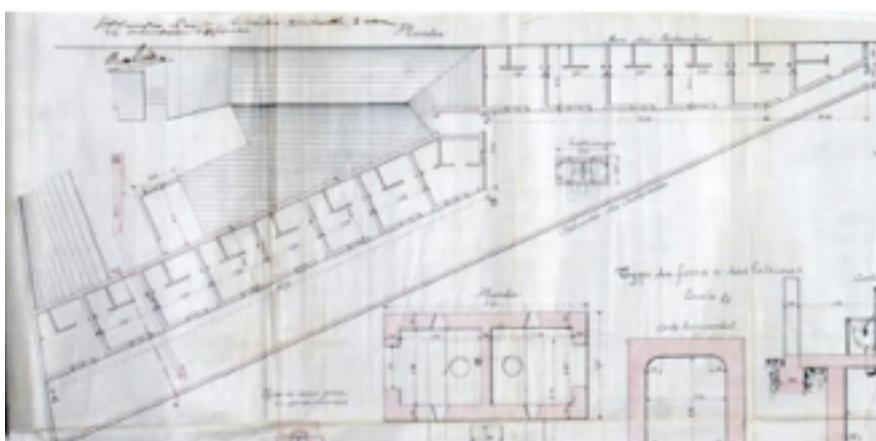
Planta da Ilha Pinheiro da Fonseca³⁰
